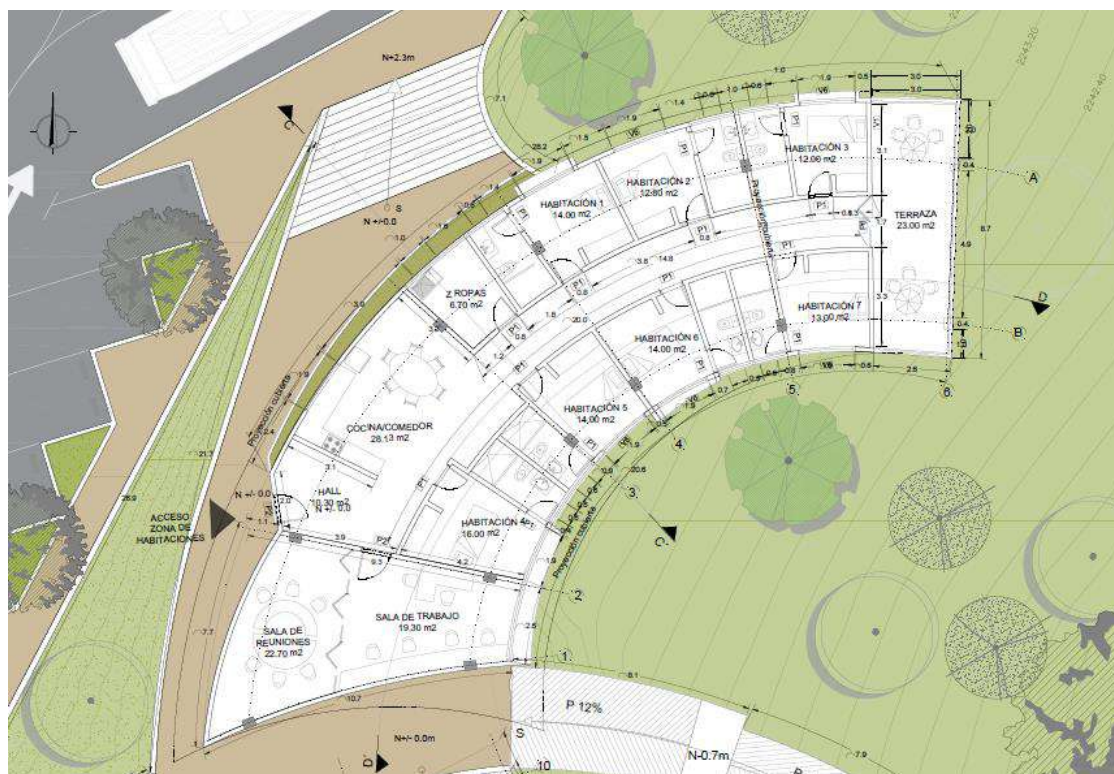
Planta ubicación general nivel +5.5 edificio sur
